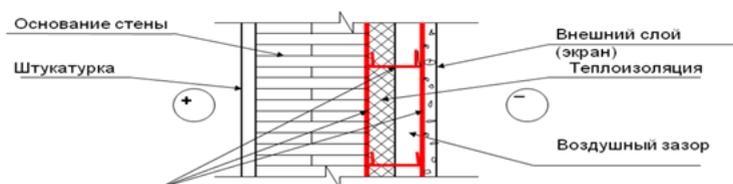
Конструкция фасадной системы с вентилируемым воздушным зазором
